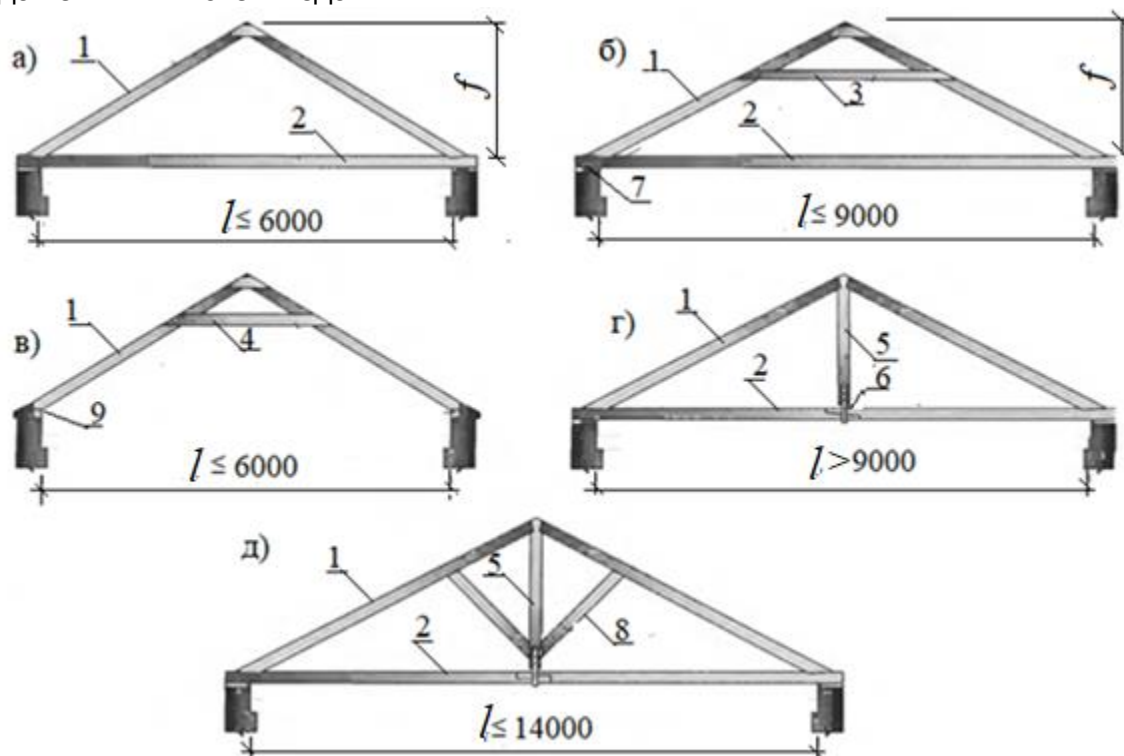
Схемы поперечных разрезов двускатных наслонных стропильных систем
